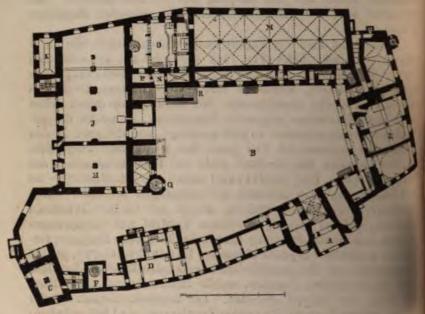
Transnitz. Grundriss des Erdgeschosses.
